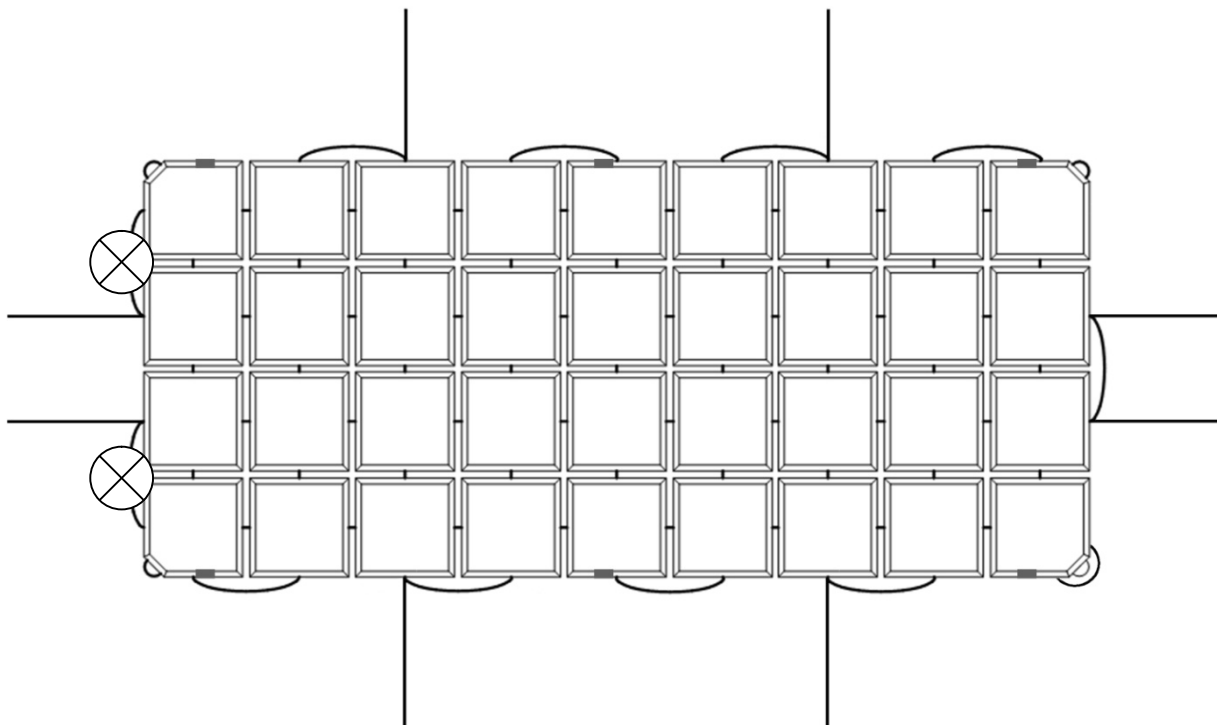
Места строповки гибкой бетонной плиты за две петли
